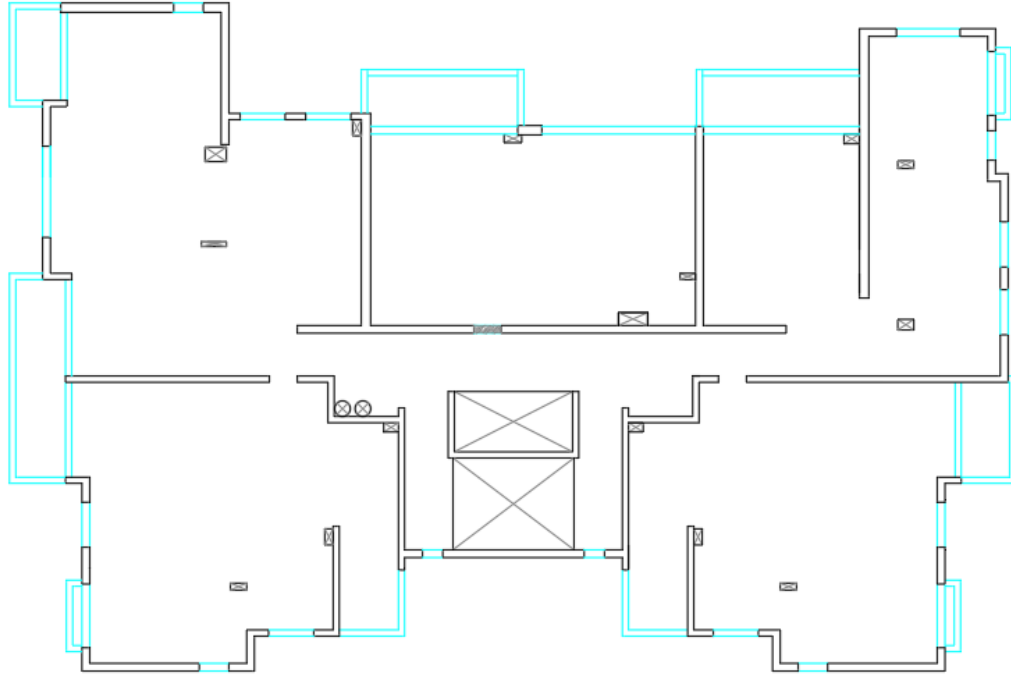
Adaptación de plano estructural de planta del piso 6.
